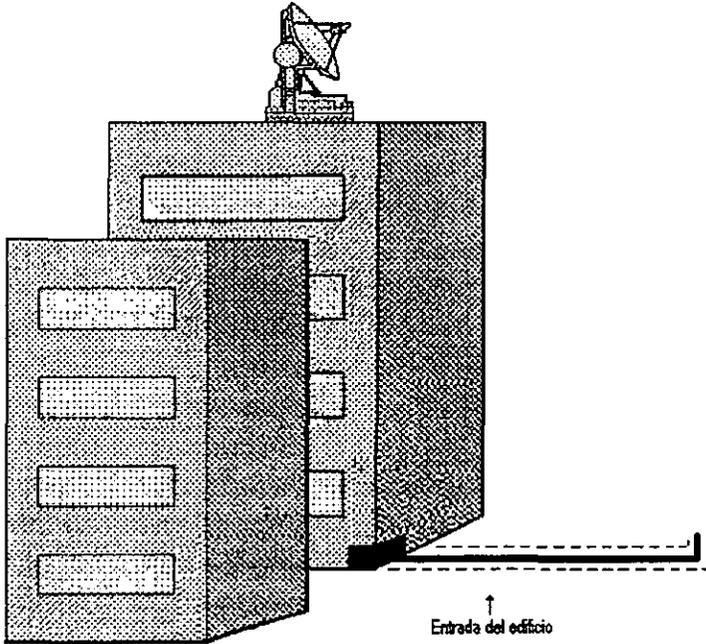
Esquema del subsistema Entrada del Edificio.
